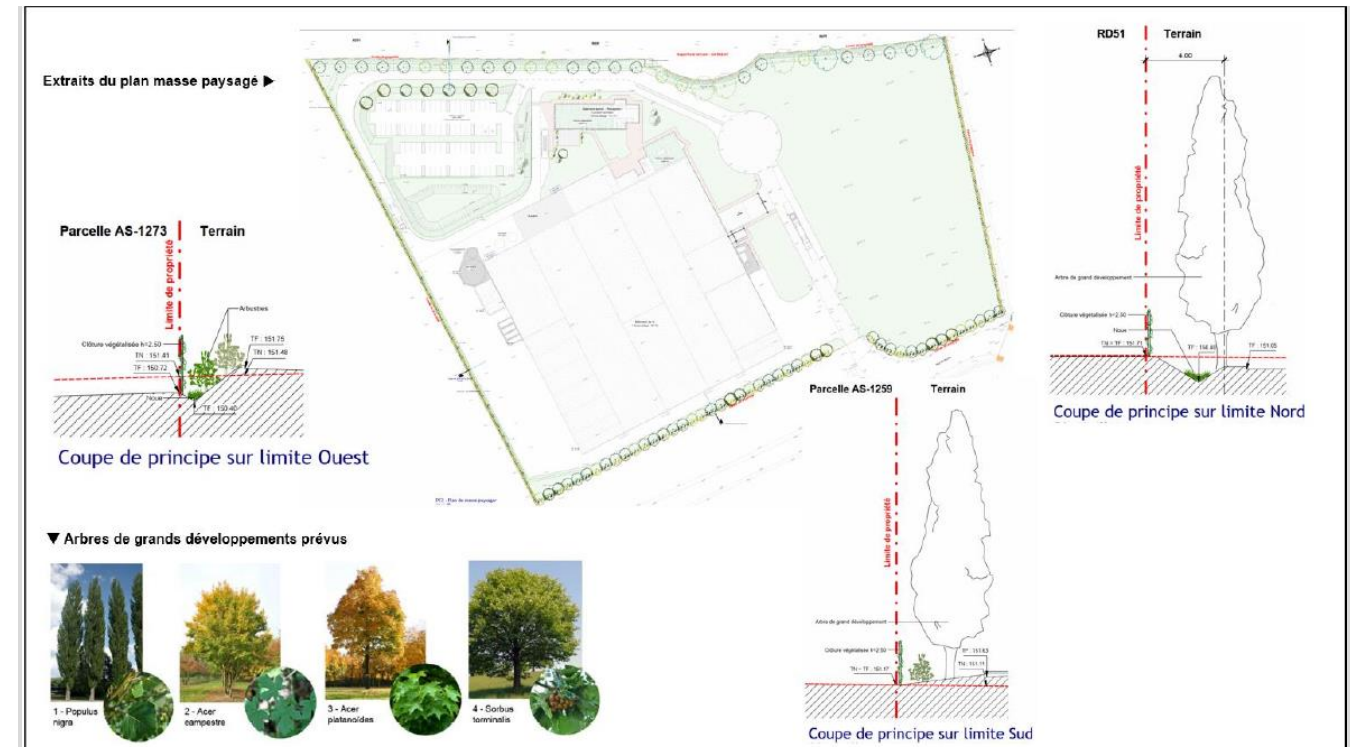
Extrait du Plan de masse paysager (©Schatzle-Weitling Architecture)
